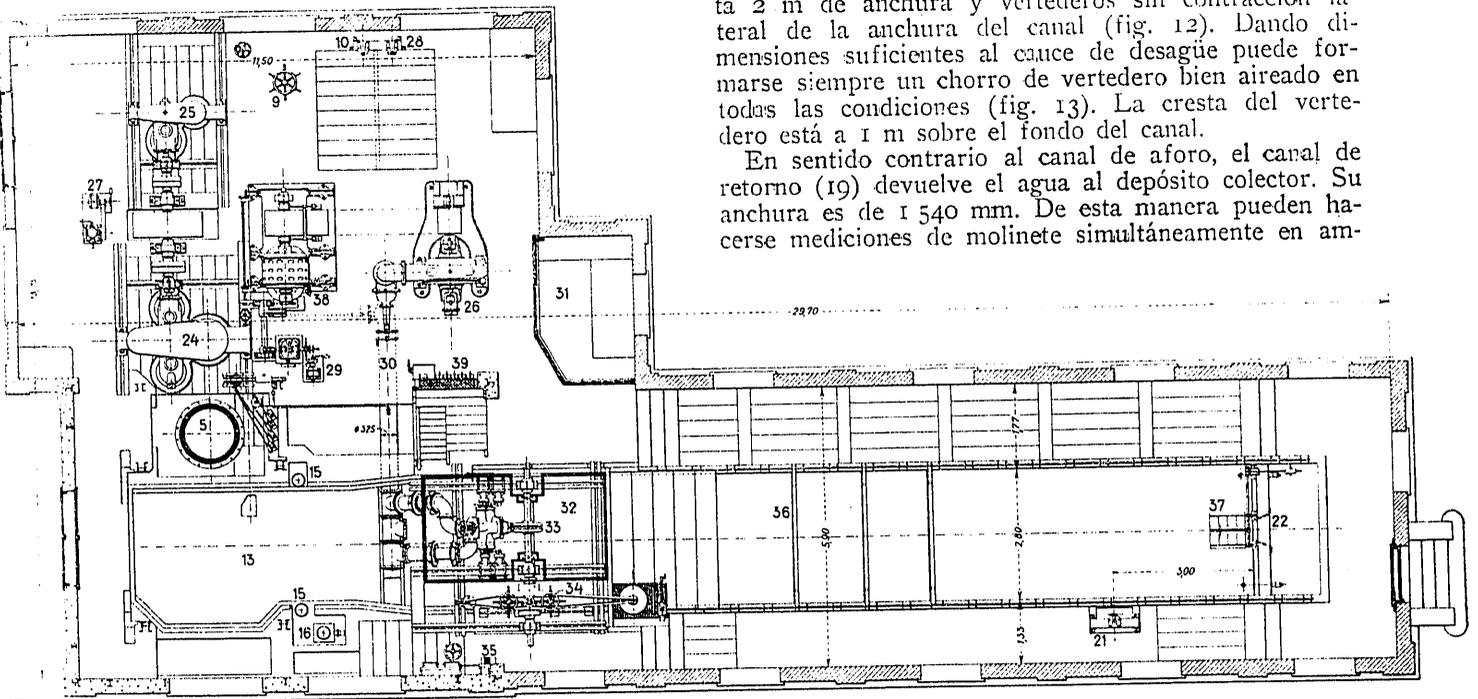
Plano de la planta baja con la instalación de máquinas, canal de aforo y corte horizontal de la cámara de ensayos de turbinas de alta presión. Escala, 1 : 100
